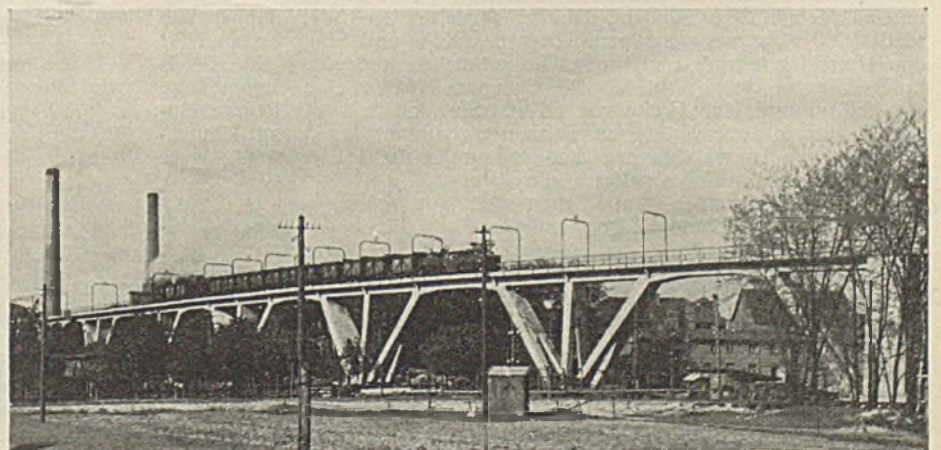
Kohlenhochbahn der Ilse-Bergbau A.-G. auf Grube Eva-Renata. Ausführung: Beton- und Monierbau A.-G.
